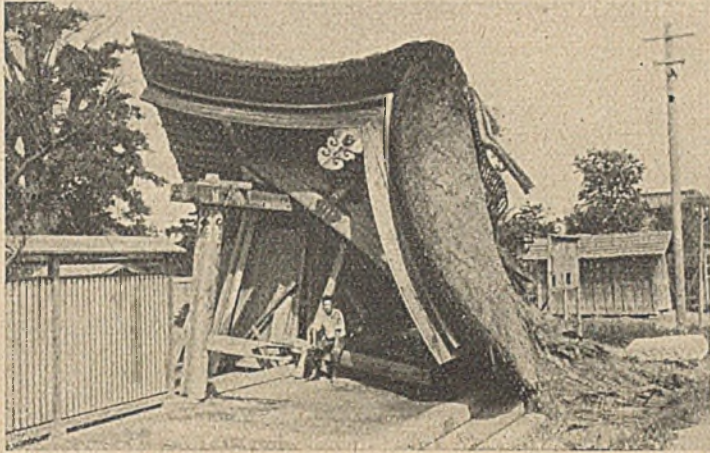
Japanisches Haus (schweres Dach auf leichtem Ständerfachwerk).
